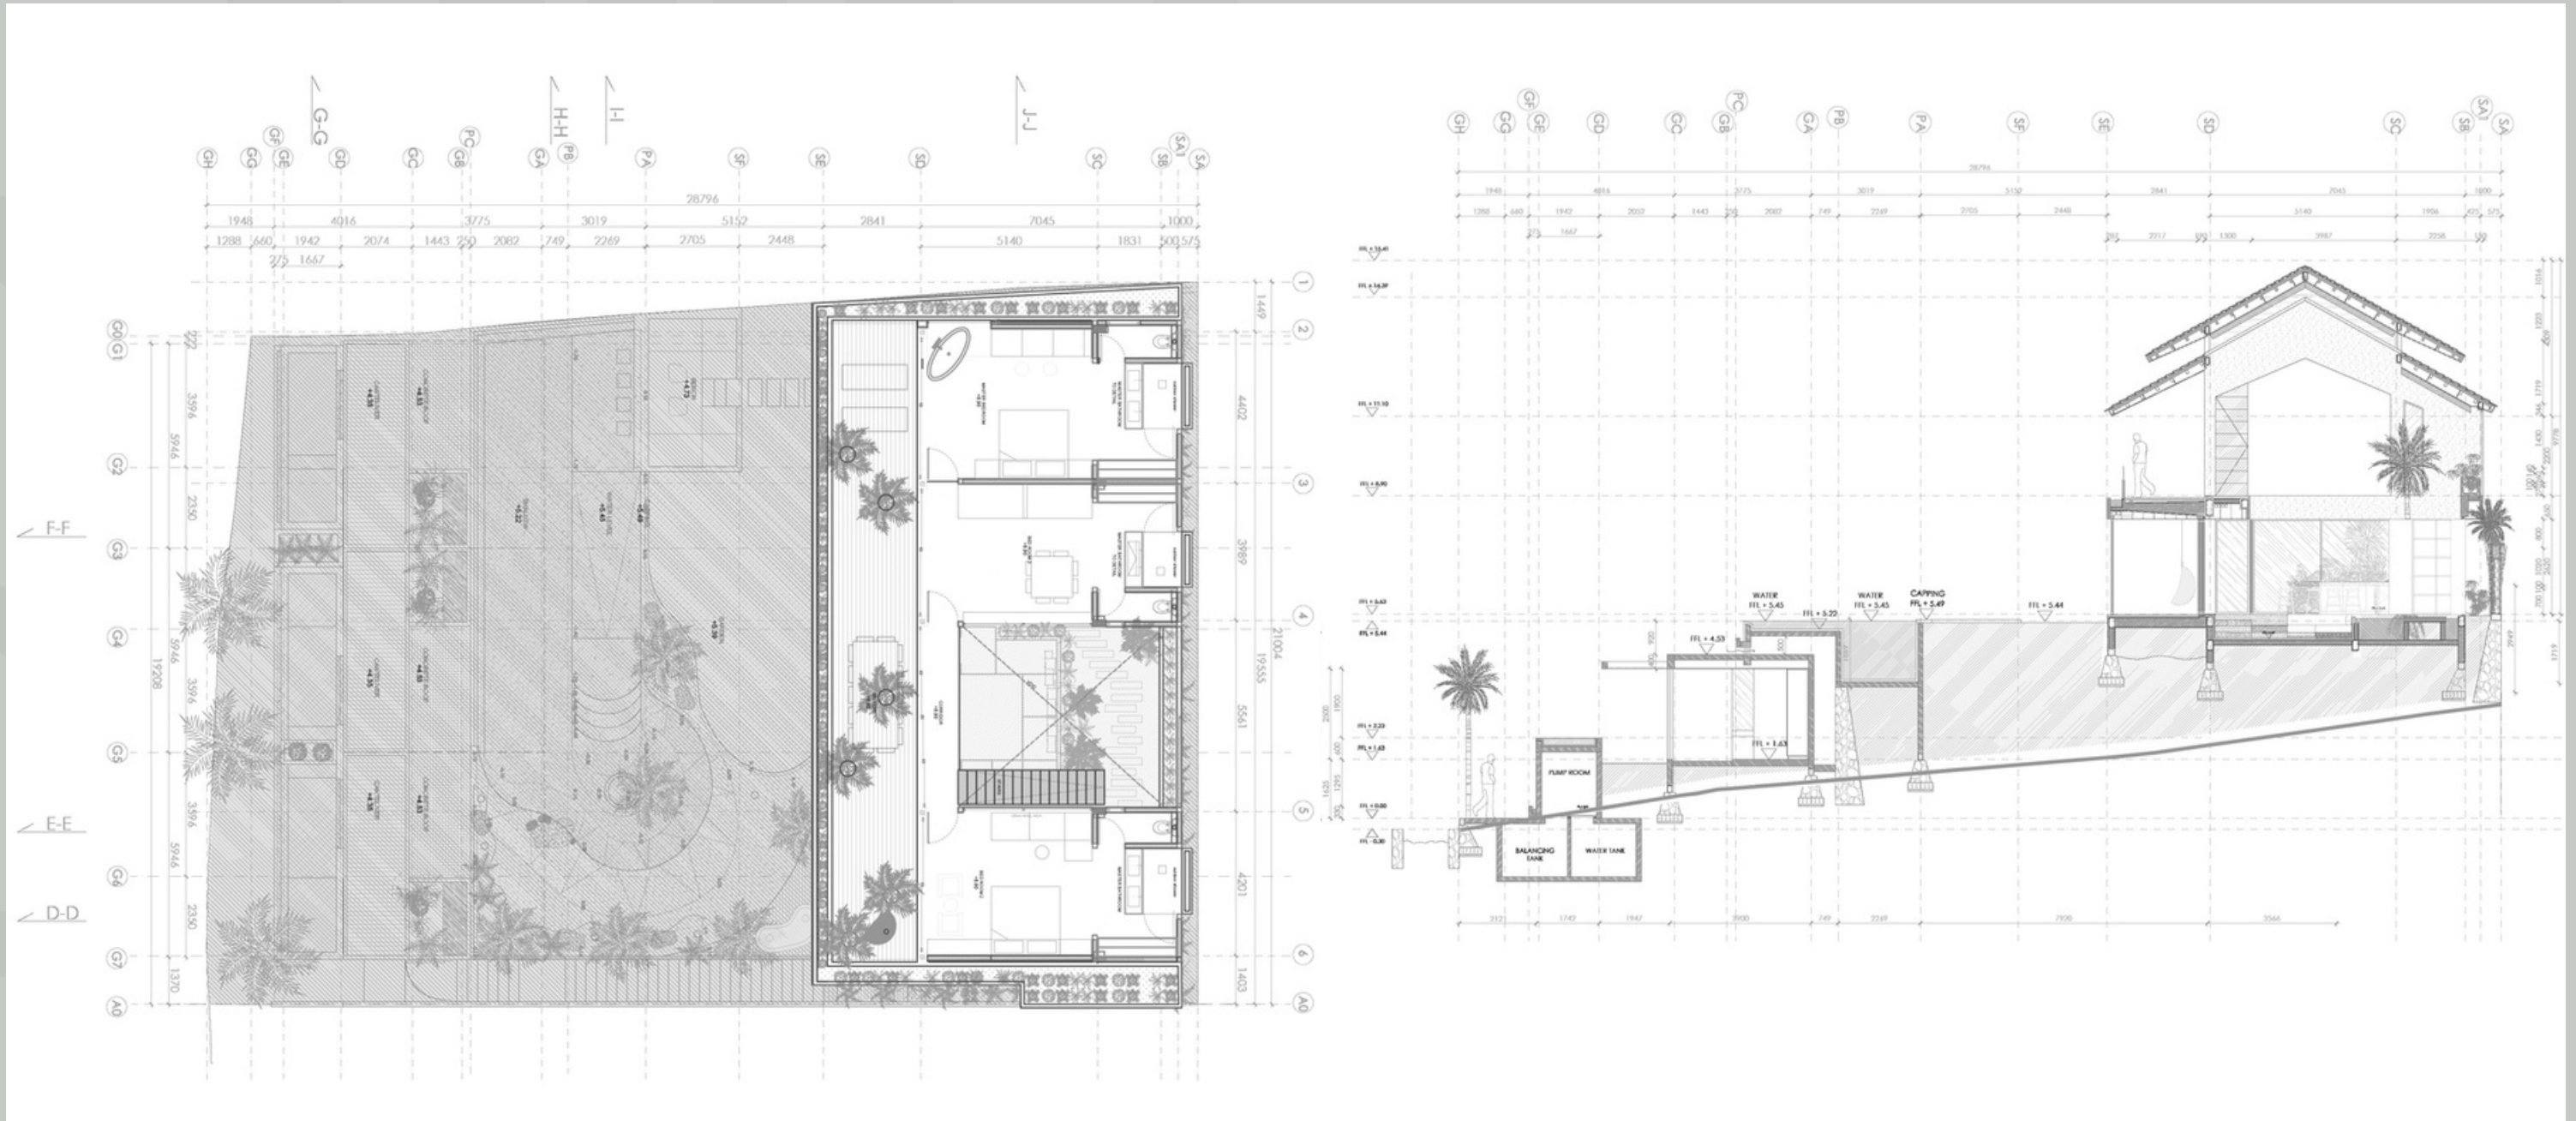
Cala Saona House. Planta do Segundo Pavimento. Fonte: Escritório Biombo Architects.
